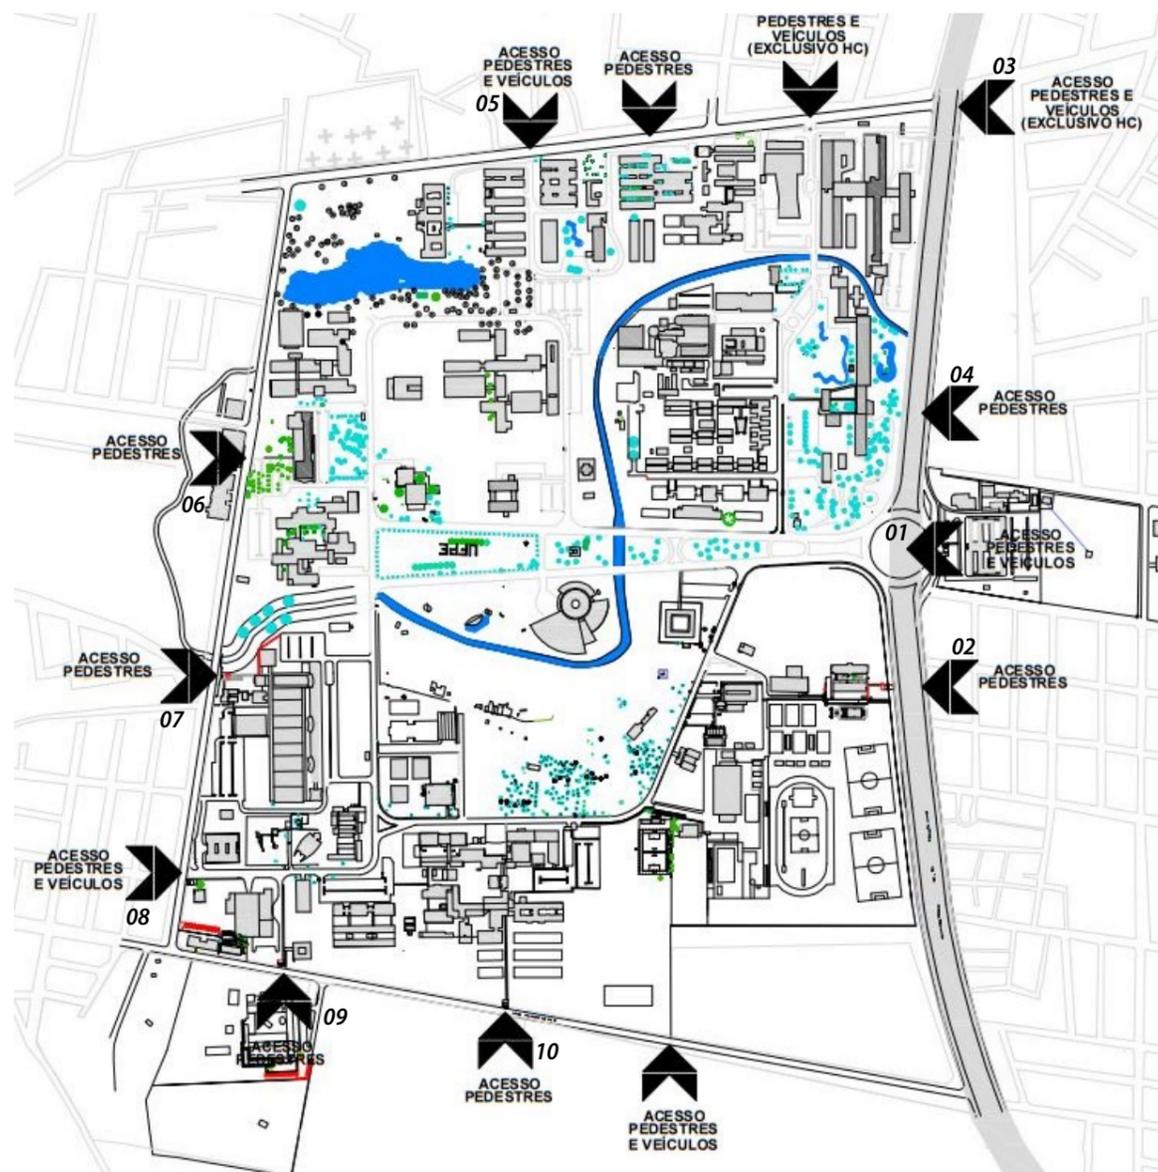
Planta geral Campus Joaquim Amazonas - Edificações existentes, em construção e planejadas.
